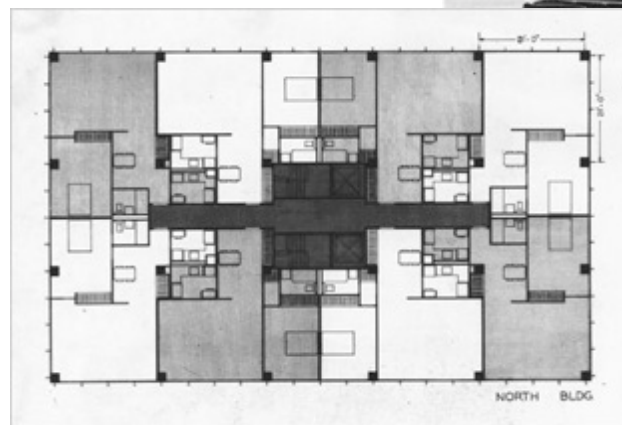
Planta tipo - Apartamentos *Lake Shore Drive* 1948.
